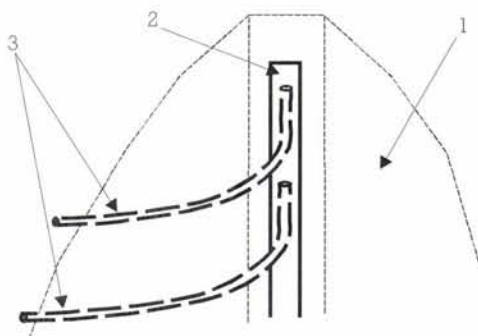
Schéma du dispositif d'évacuation du drain cheminée par secteurs.
